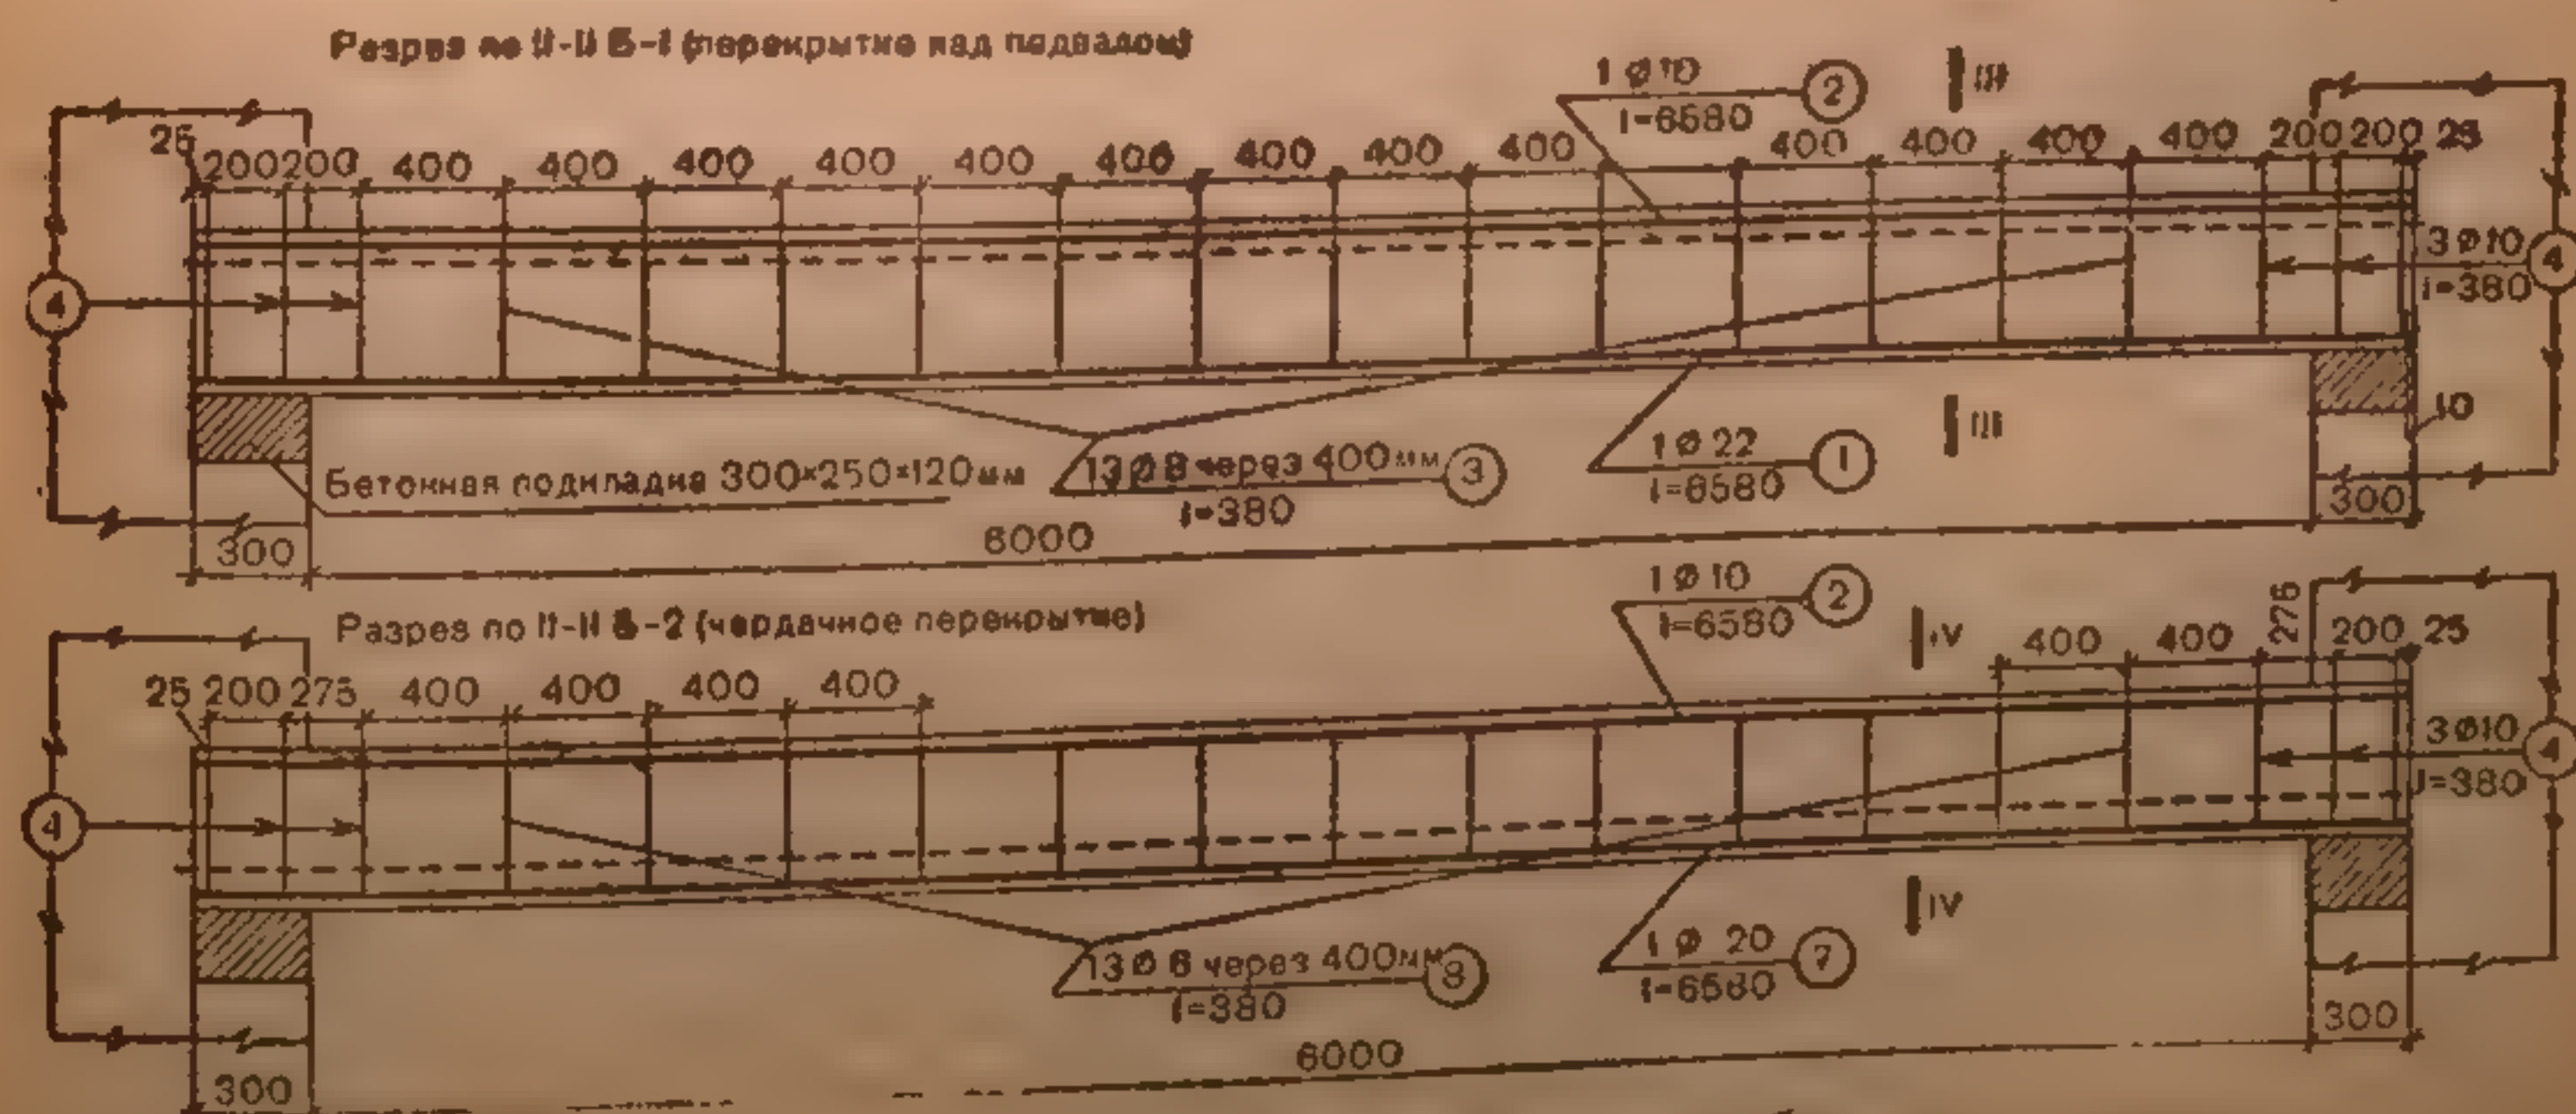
Разрез сварных каркасов двух балок по длине
